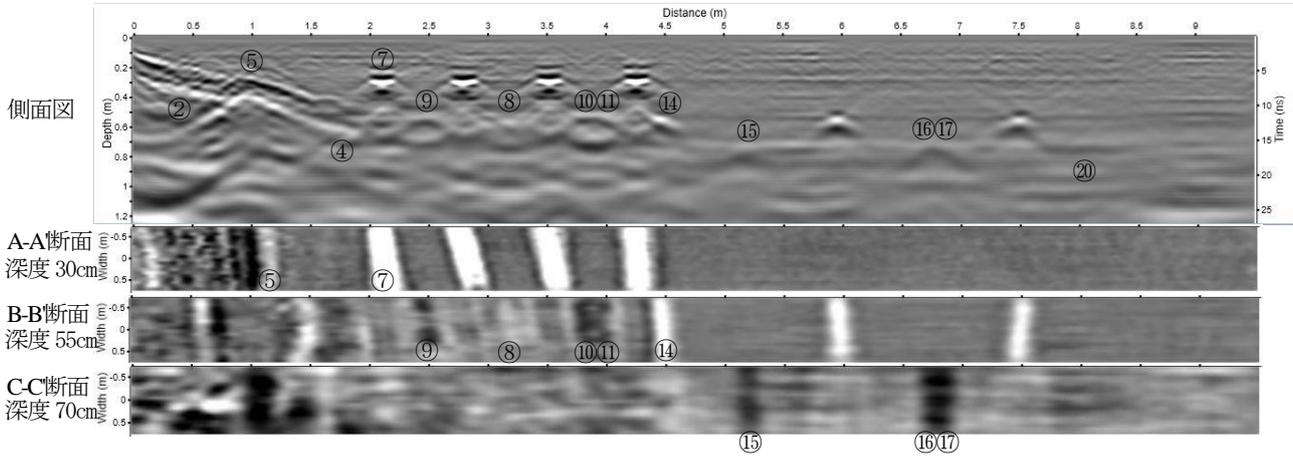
試験設備側面図, およびレーダー解析画像 (側面図, 平面図 (深度 30cm, 55cm, 70cm))
